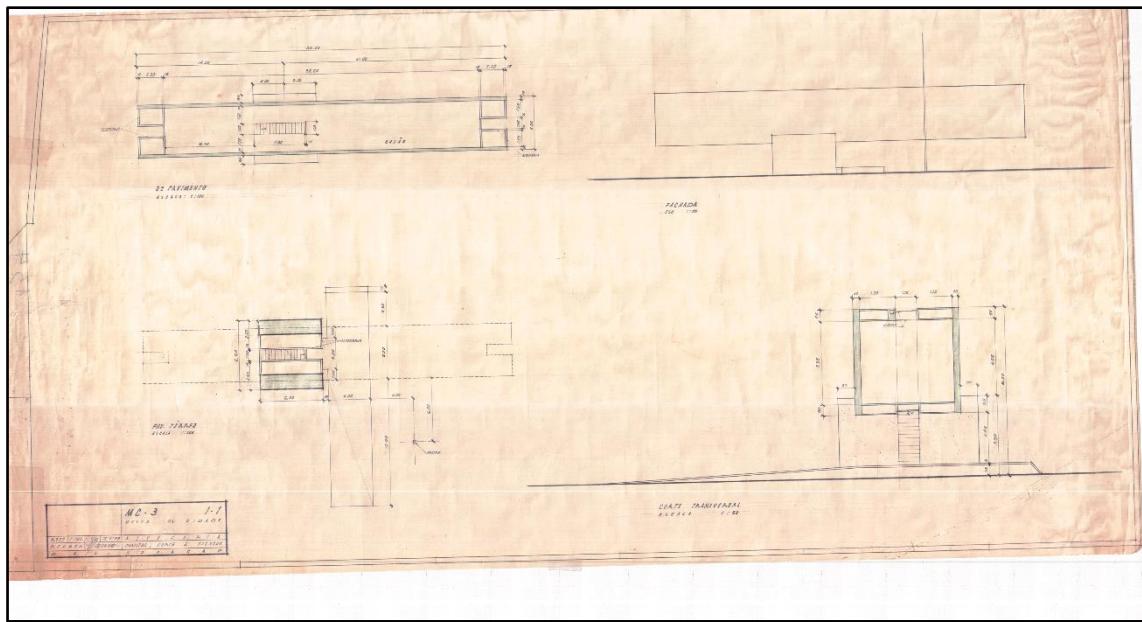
Abr. 1959 – Museu da Cidade. M.C.-3 1-1 Escalas 1:50 e 1:100. Alvenaria - Plantas, Corte e Fachada. D.U.A.-NOVACAP. Arquivo: MC - ARQ - 000-0 - 001-01 - B000977 - 1959-04 - Alvenaria - Plantas, corte e fachada. Fonte: SUPAC/SECULT-DF.
